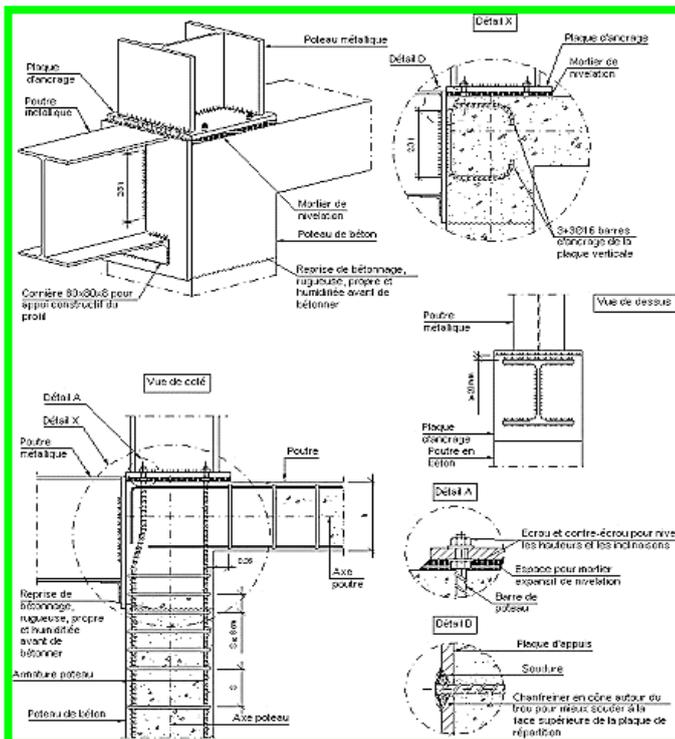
Articulazione poutre metallica con colonna in cemento armato
